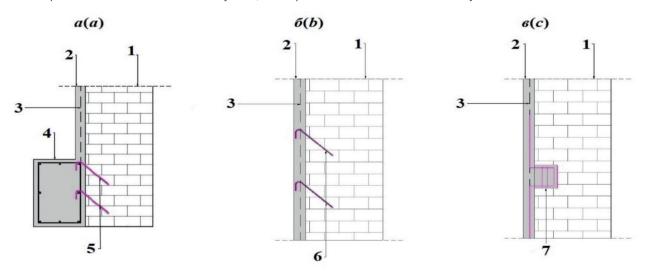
Детали одностороннего торкретирования бетоном каменной стены:
